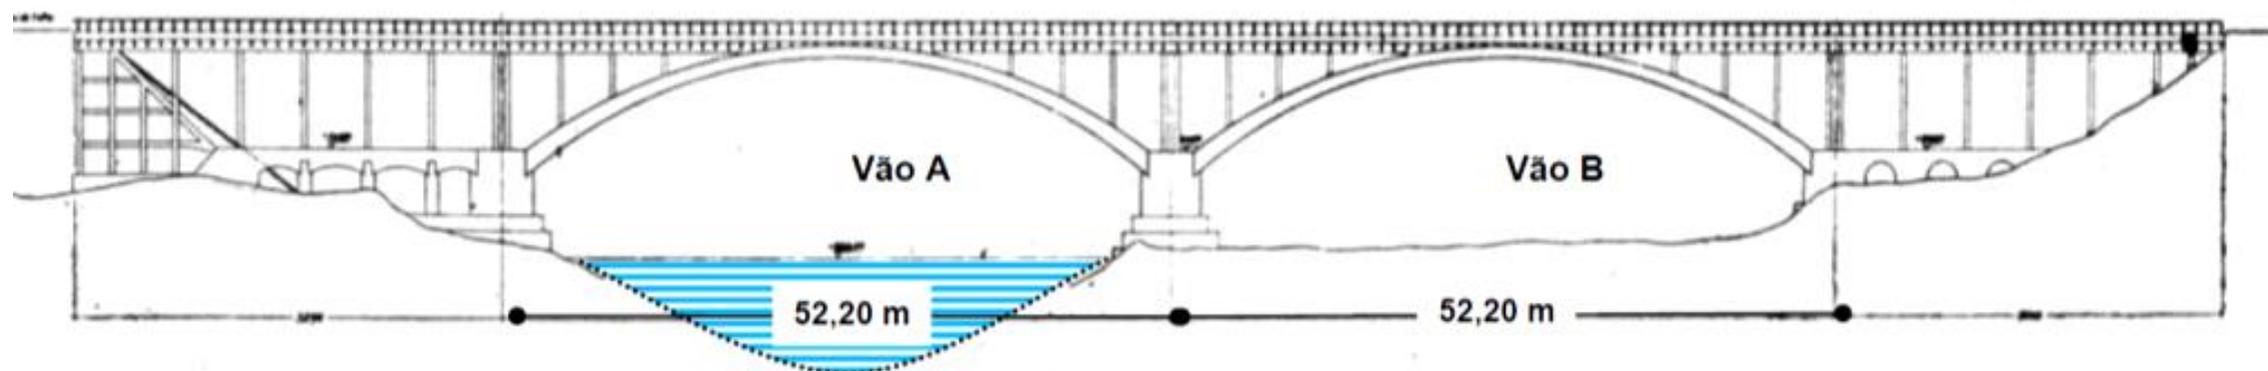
Elevação da ponte ferroviária sobre o Rio Paranaíba
